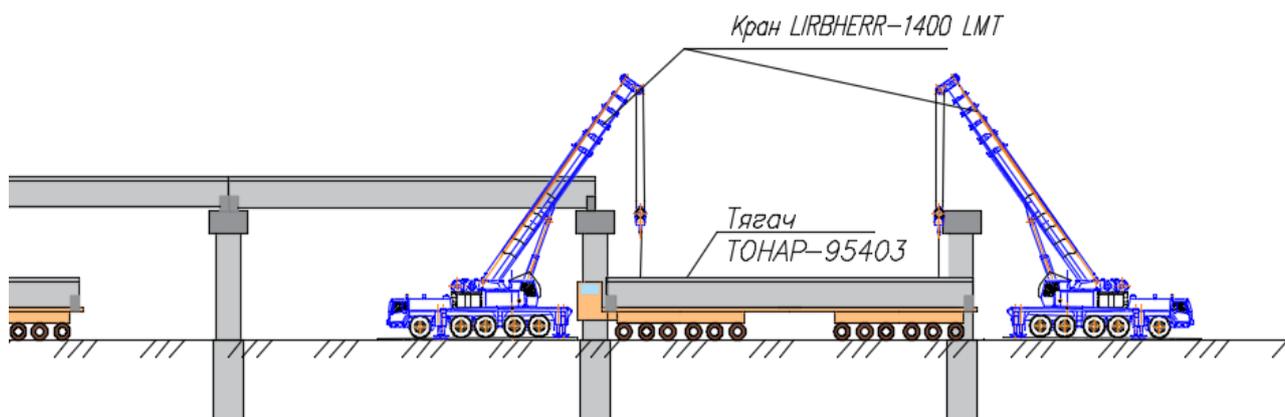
Монтаж балочных пролетных строений стреловыми кранами
